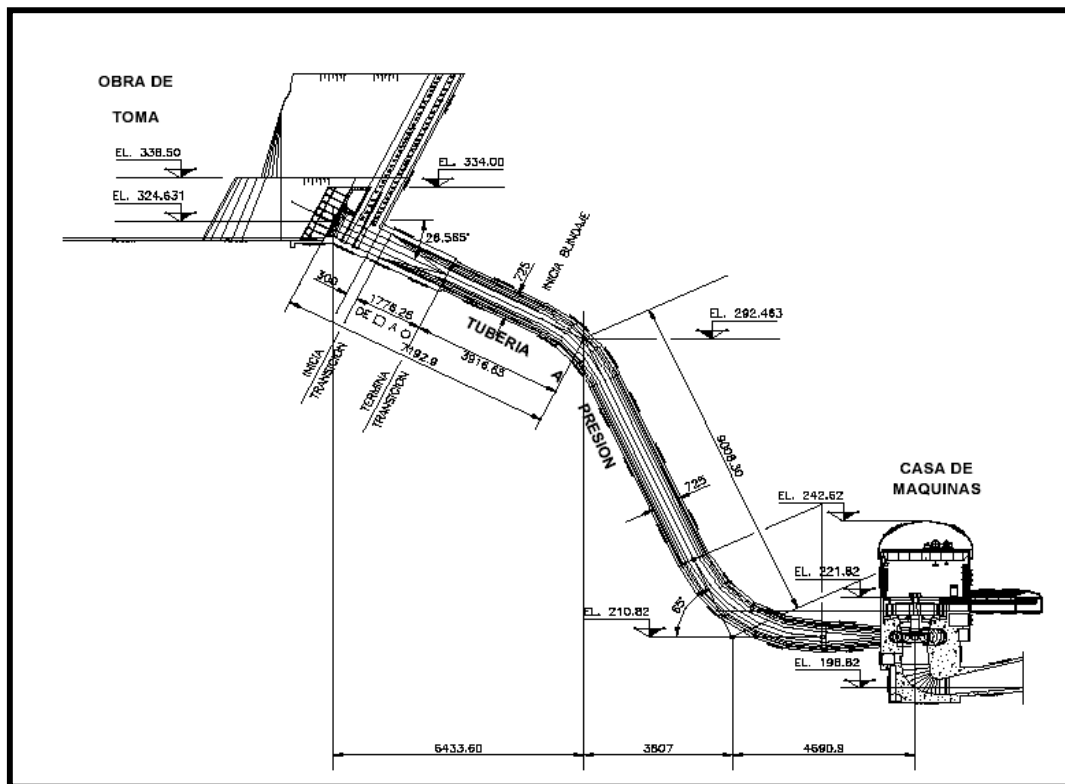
Corte longitudinal por el eje de la conducción de las tuberías a presión
